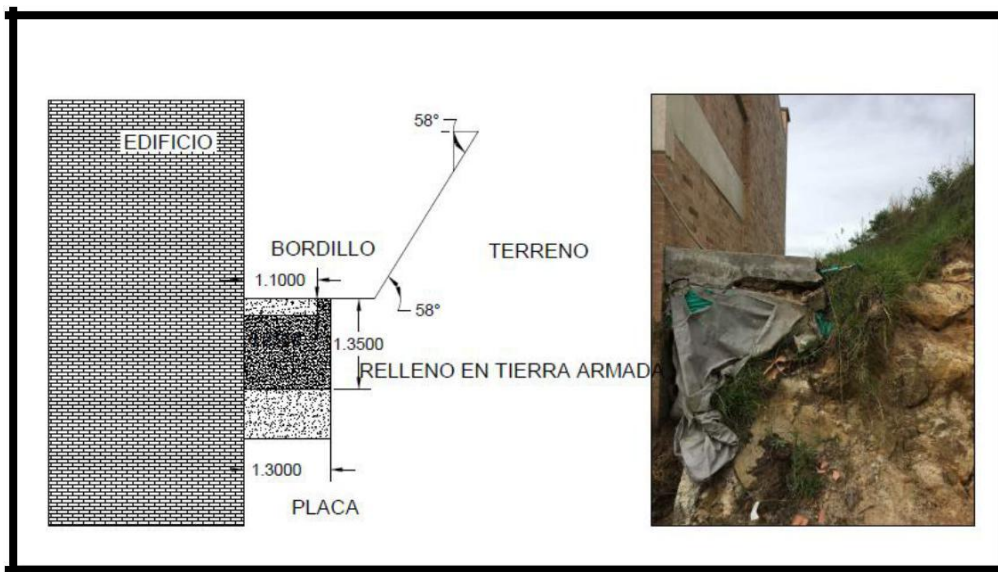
Corte Transversal - Zona Edificio Femenino.
